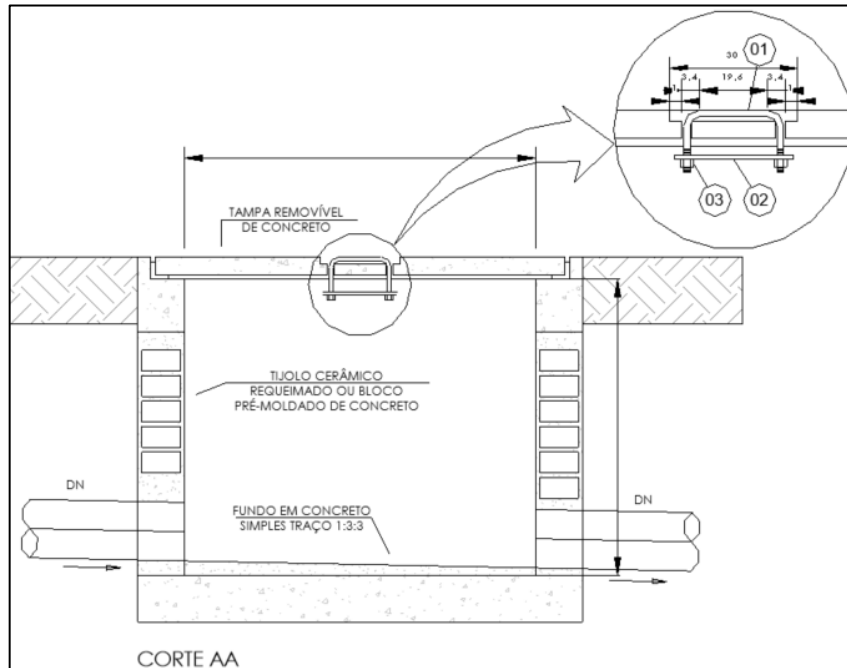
Detalhe caixa de areia com tampa de concreto
